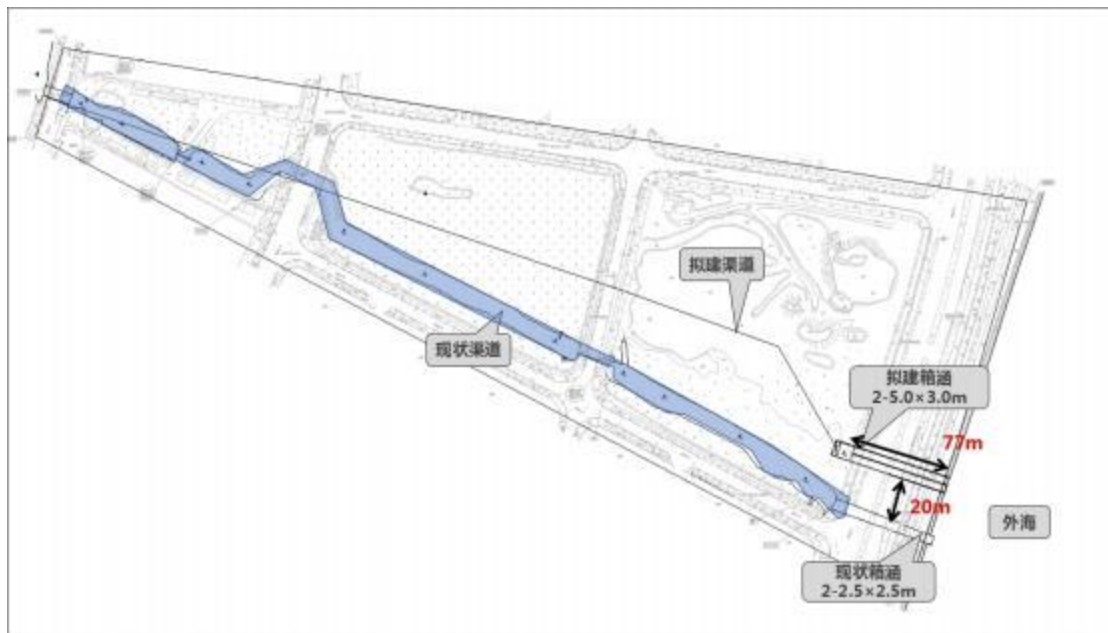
本项目 3-3 号排洪渠施工期排水示意图
